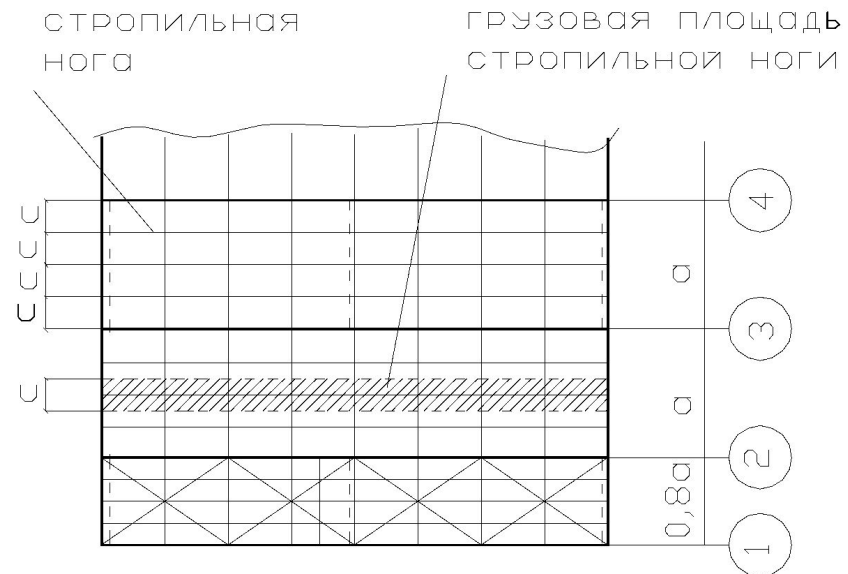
Фрагмент плана покрытия здания, определение грузовой площади стропильной ноги
